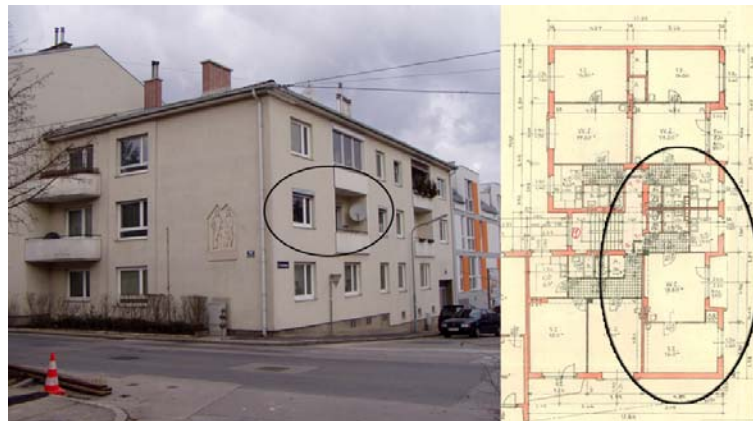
Wohnungsbeispiel Bukalgasse, Außenansicht und Grundriss
